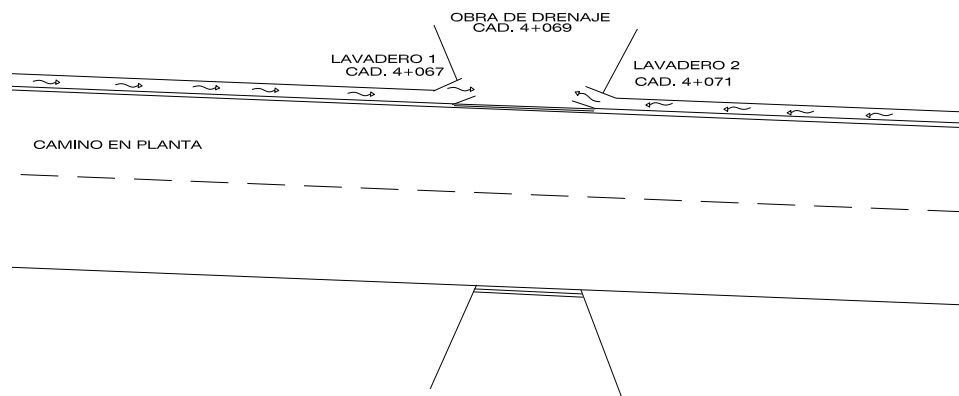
Ubicación de lavaderos 1 y 2 salida hacia alcantarilla cad. 4+069.
